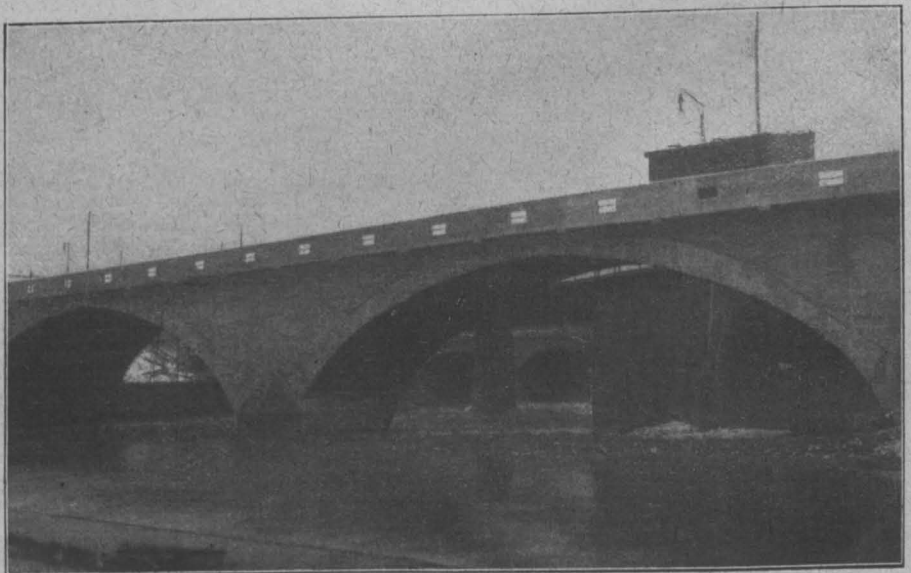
Bild des fertigen Brücken-Bauwerkes.
